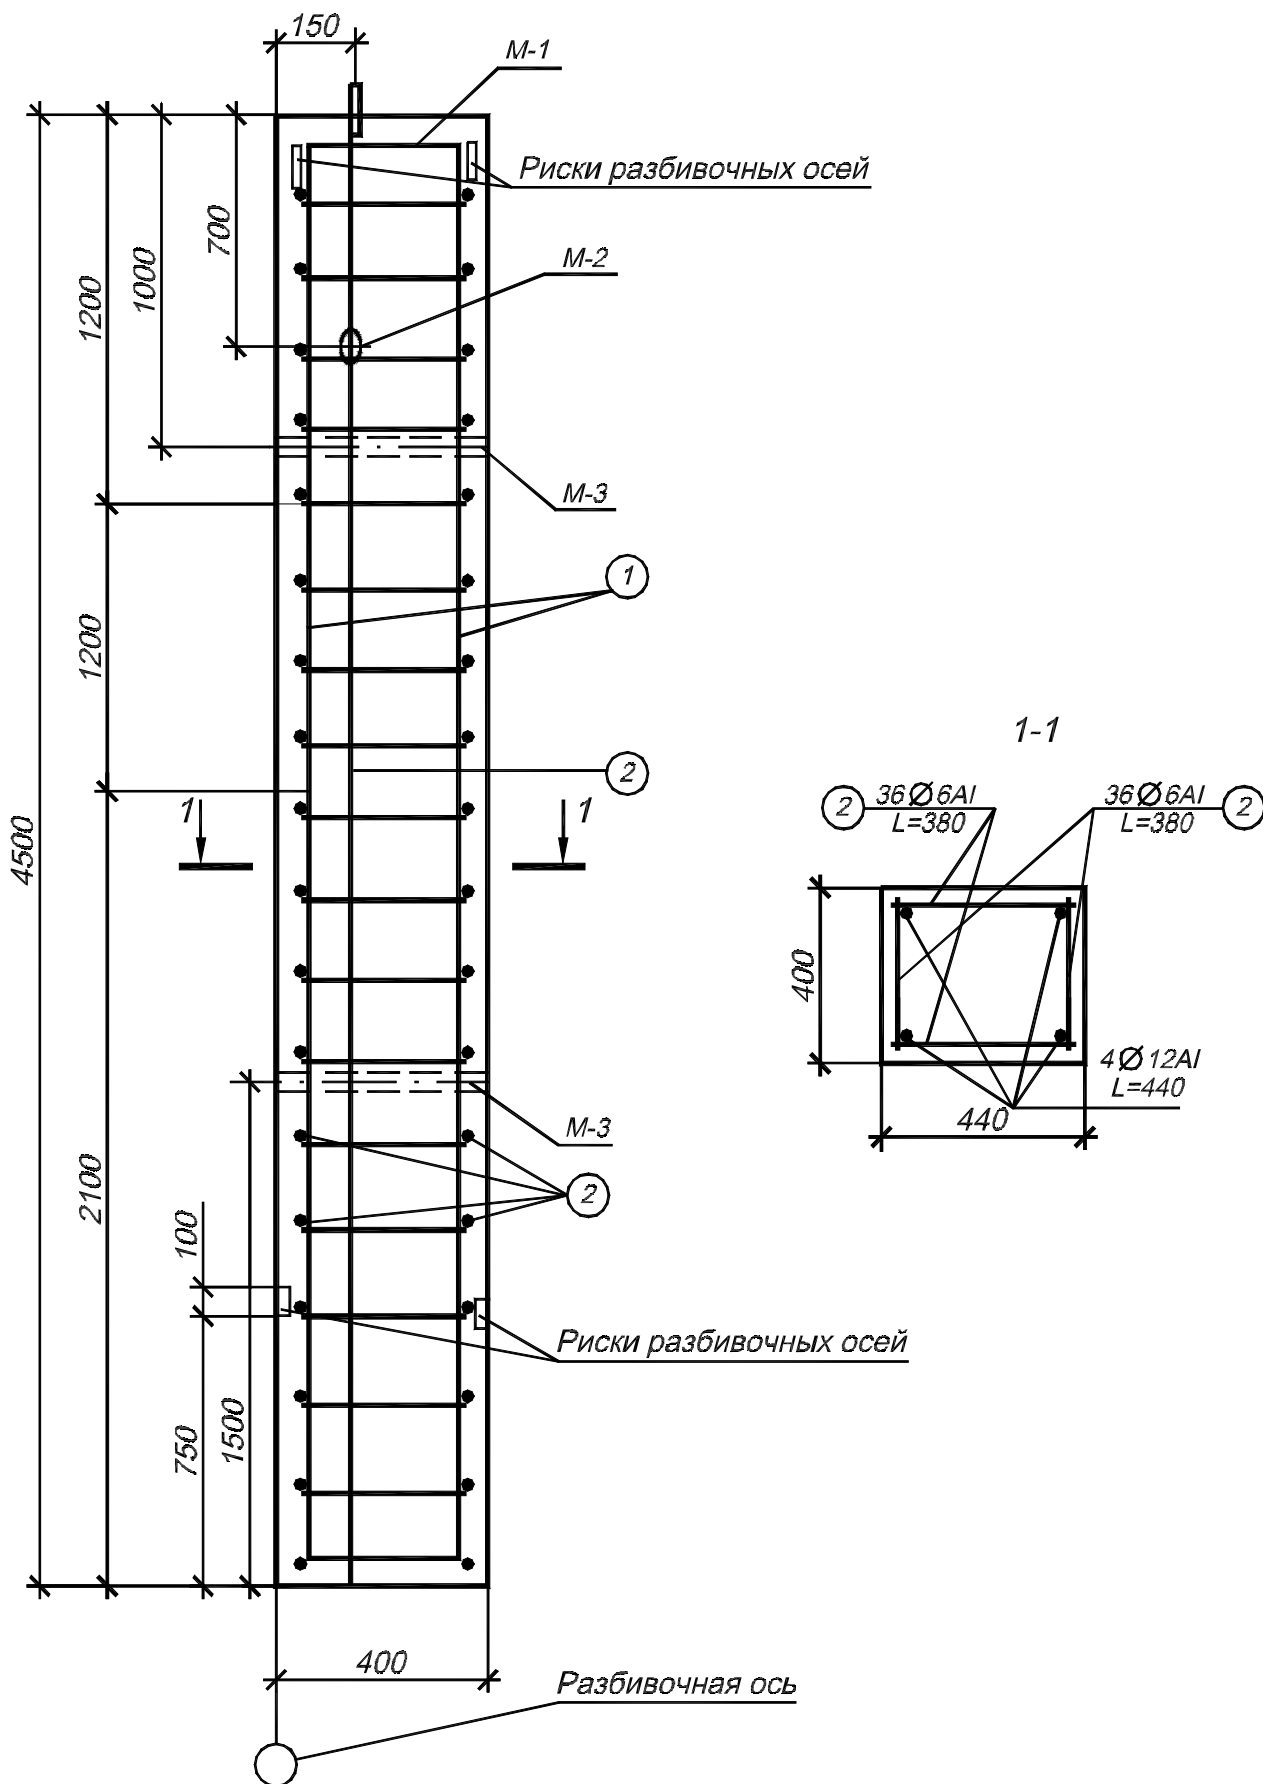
Варианты 21, 22, 23, 24, 25 задания «Железобетонные конструкции». Колонна КП II-I
